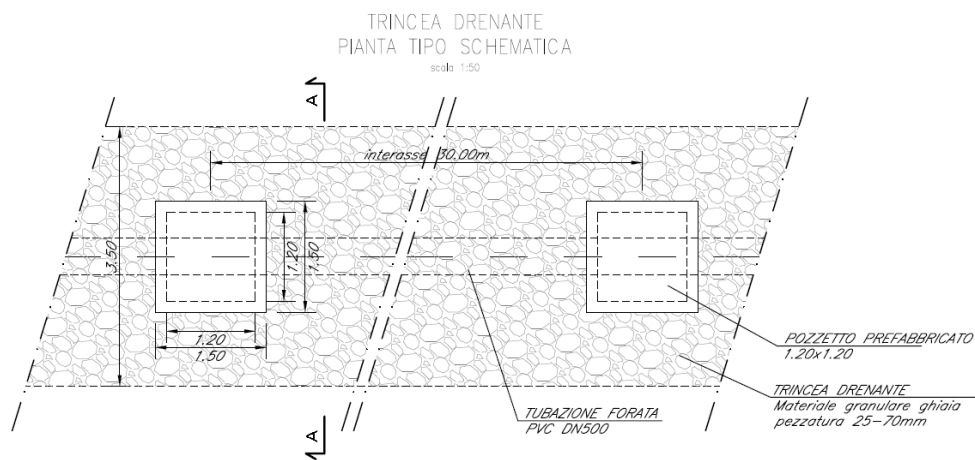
Trincea Drenante – Pianta tipo schematica
